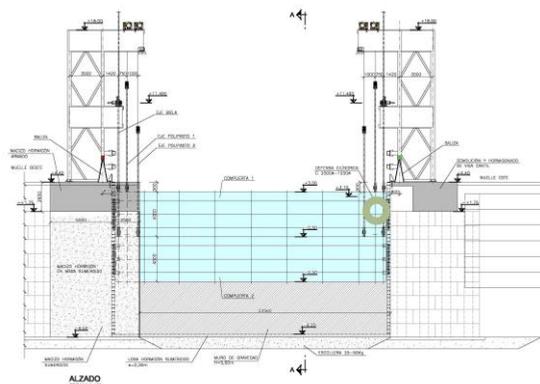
Alzado de la Compuerta, Torres de Cuelgue y Sistema de Elevación
